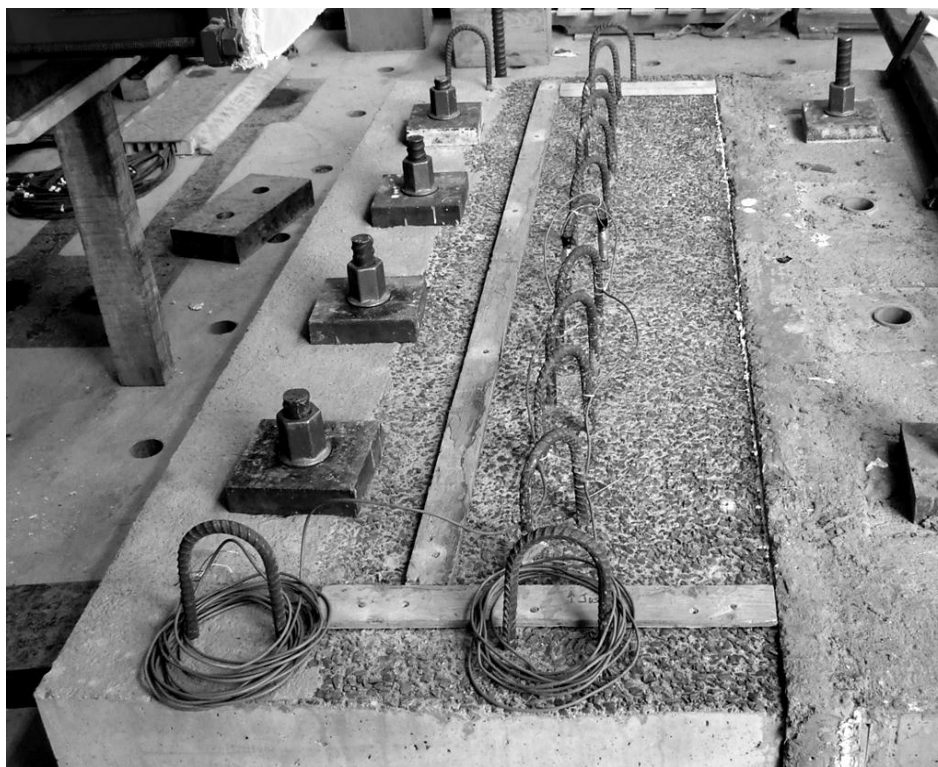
Dalle d'ancrage avec barres d'armatures en U
